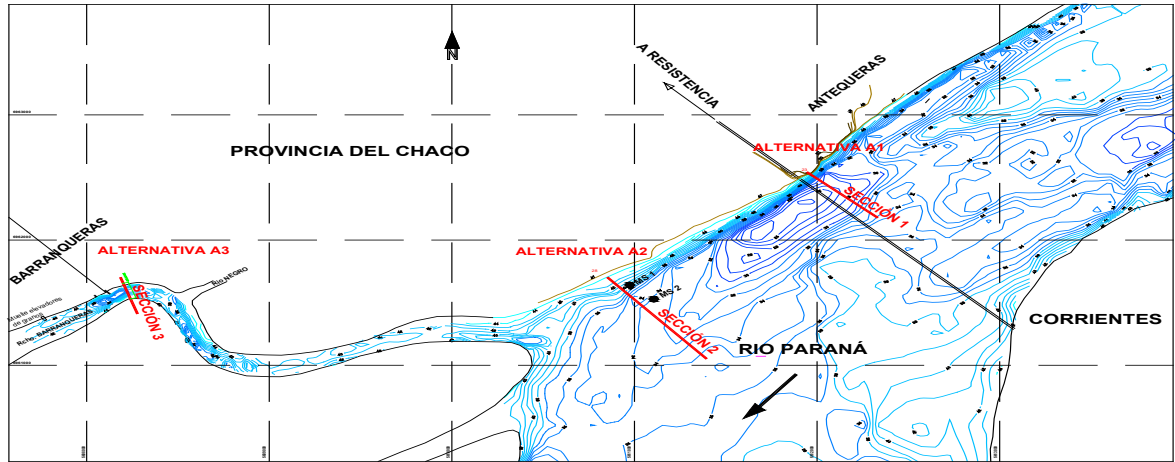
Ubicación de las secciones de emplazamiento de las alternativas. (Fuente: FICH).
